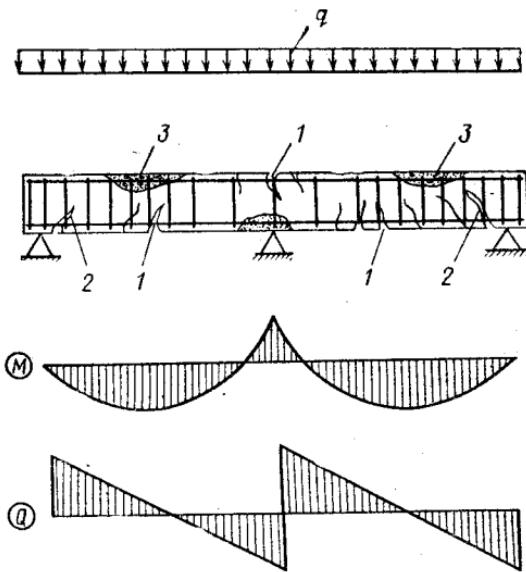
Характерные трещины в изгибаемых железобетонных элементах, работающих по балочной схеме:
